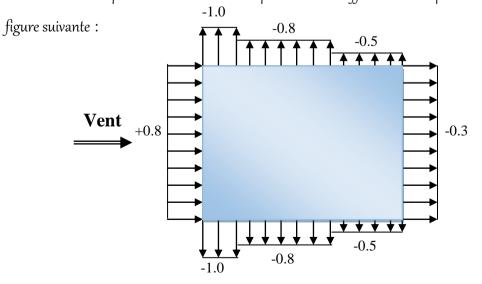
Répartition de Cpe sur les parois verticales - Direction du vent V1.
